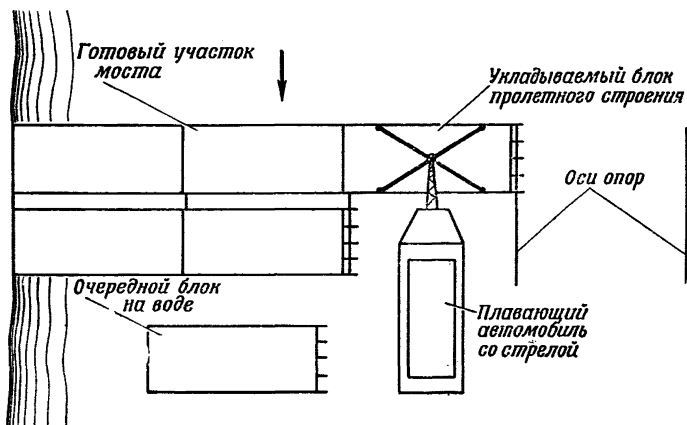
Схема укладки блоков пролетного строения на опоры стрелы, установленной на плавающем автомобиле (транспортере)
